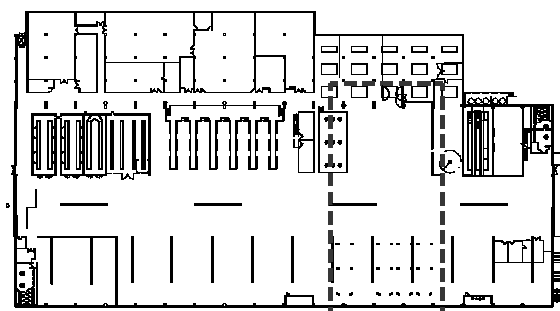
Troço da Nave 1 em maqueta a tracejado
